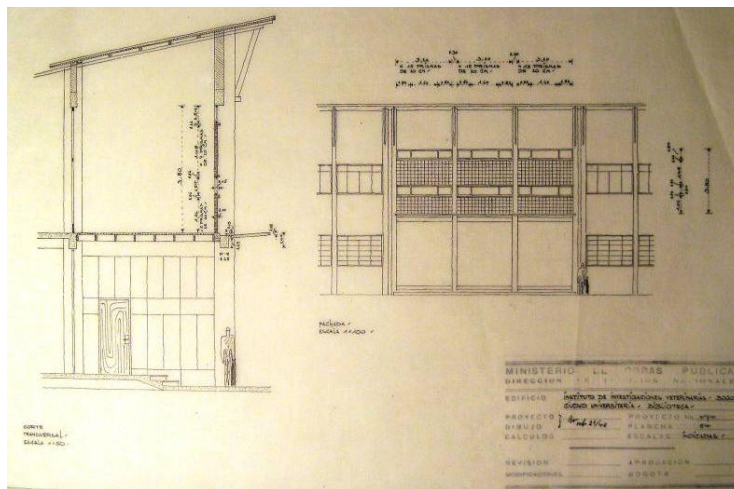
Schnitt des Hauptgebäudes. Vordach mit schrägen Holzpfosten.
